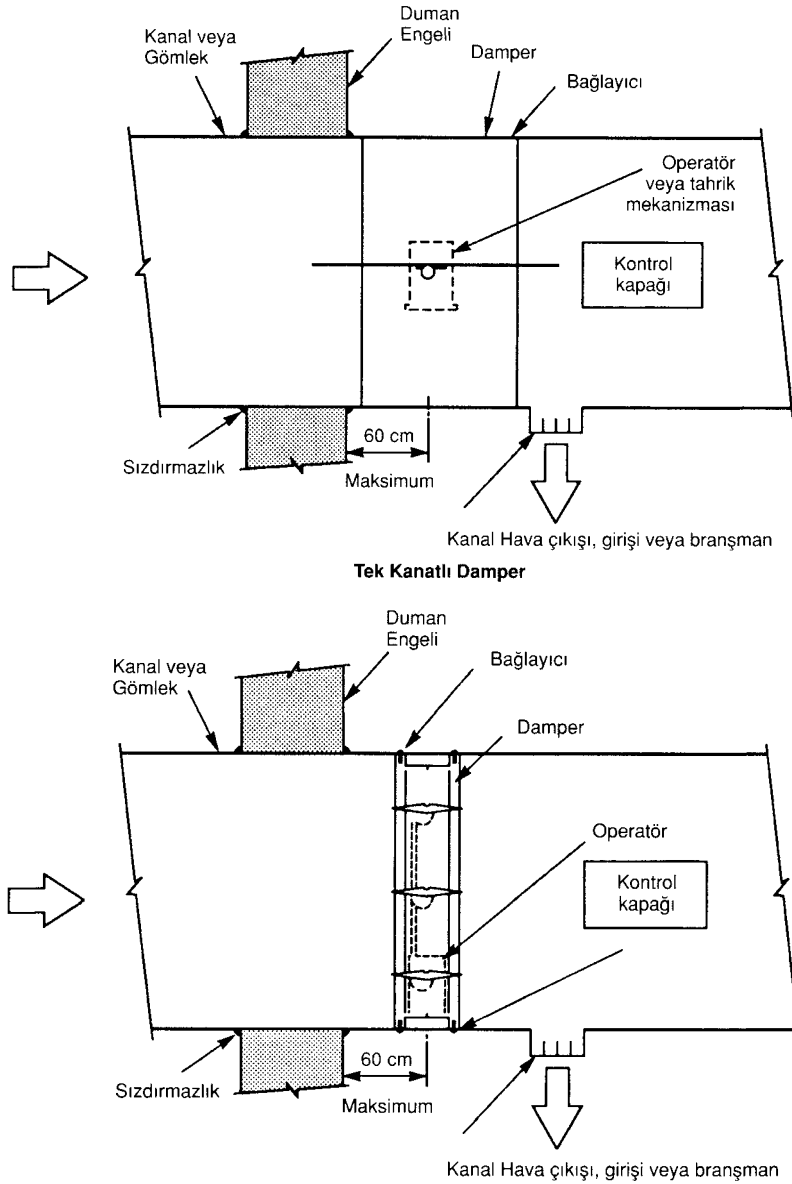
UL testinde geçmiş damper bağlantıları
